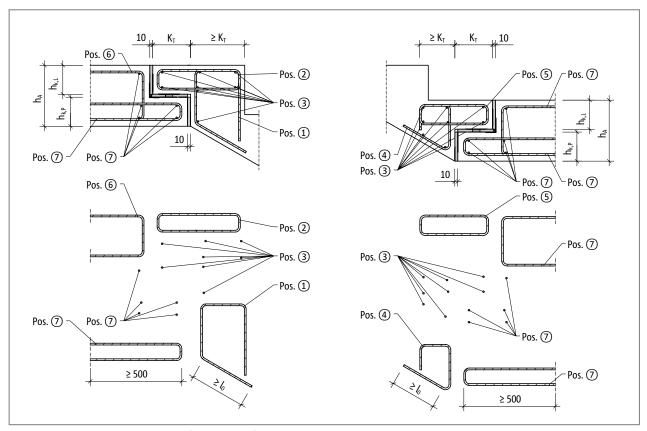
Schöck Tronsole  $^{\circ}$  type F: On-site reinforcement with flush connection
